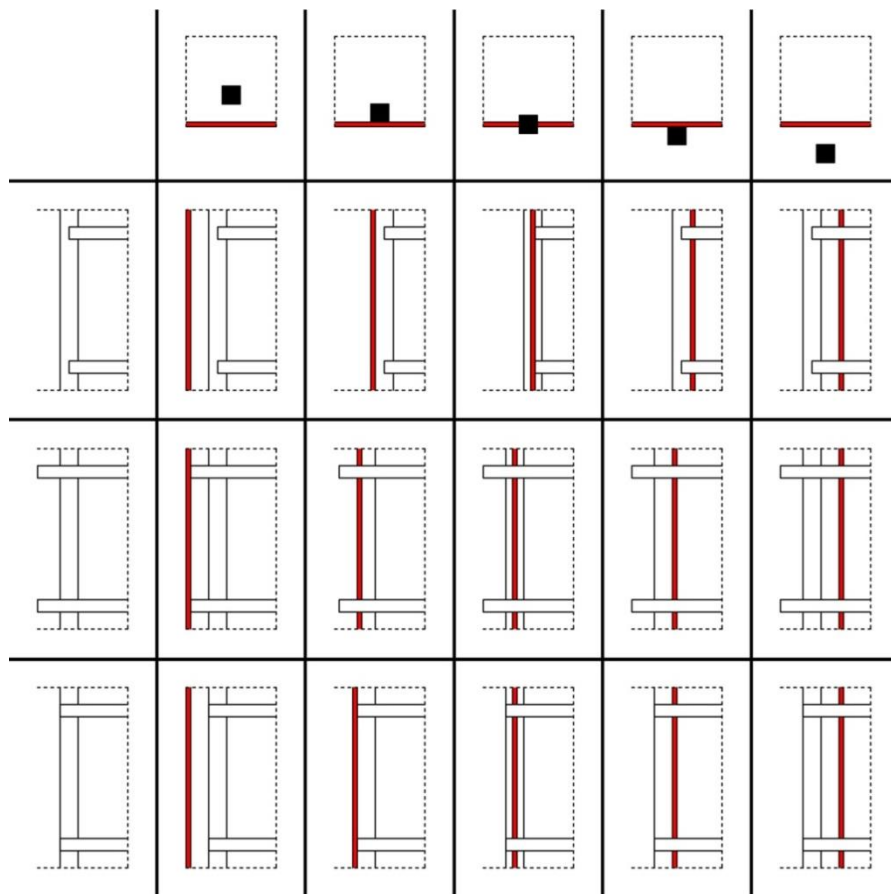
Schematizzazione del piano di facciata (in rosso) rispetto la struttura portante. Da sx: staccata e dietro la struttura, davanti la struttura, in adiacenza, compresa tra la struttura, dietro la struttura, in adiacenza, staccata dalla struttura, dietro.
